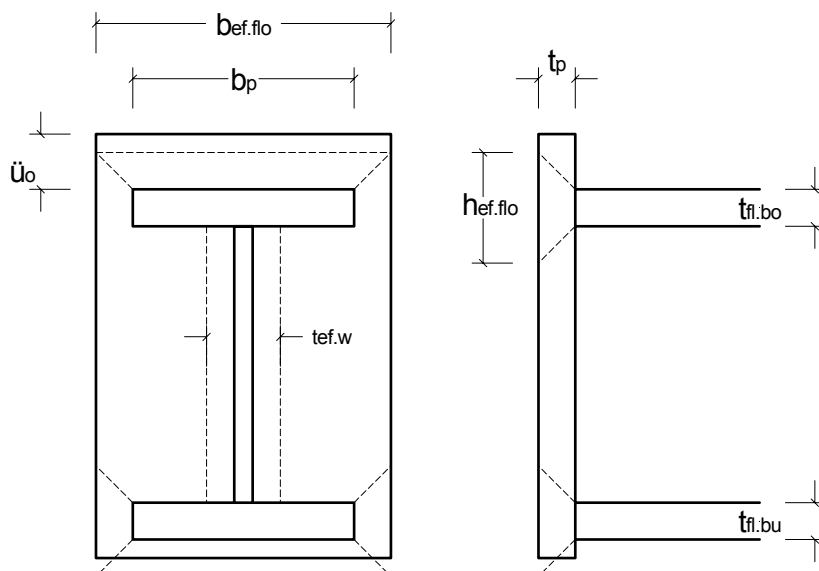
Lastausbreitungsflächen im Schnitt II
